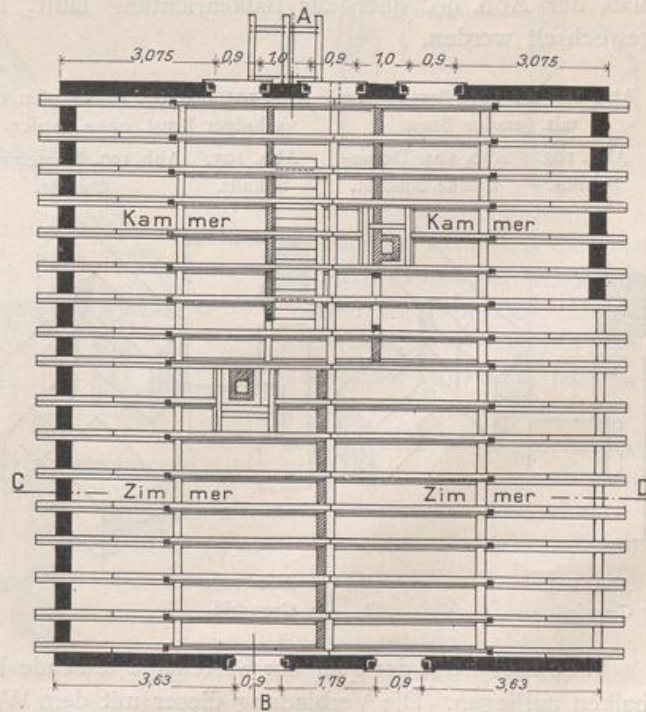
Werkplan des Dachgeschosses. M. 1 : 150.
